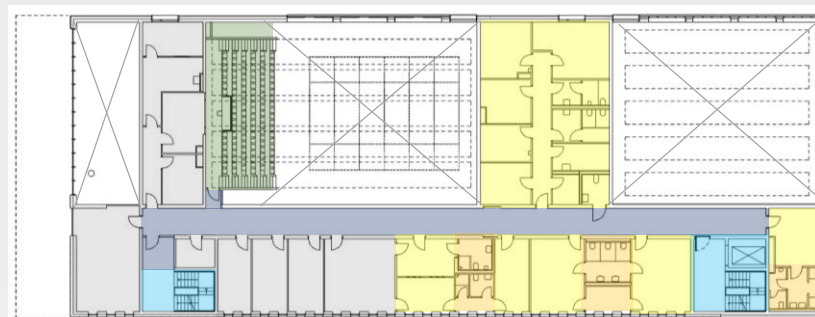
Planta Baixa do 1º pavimento (GMP ARCHITEKTEN, 2019).
